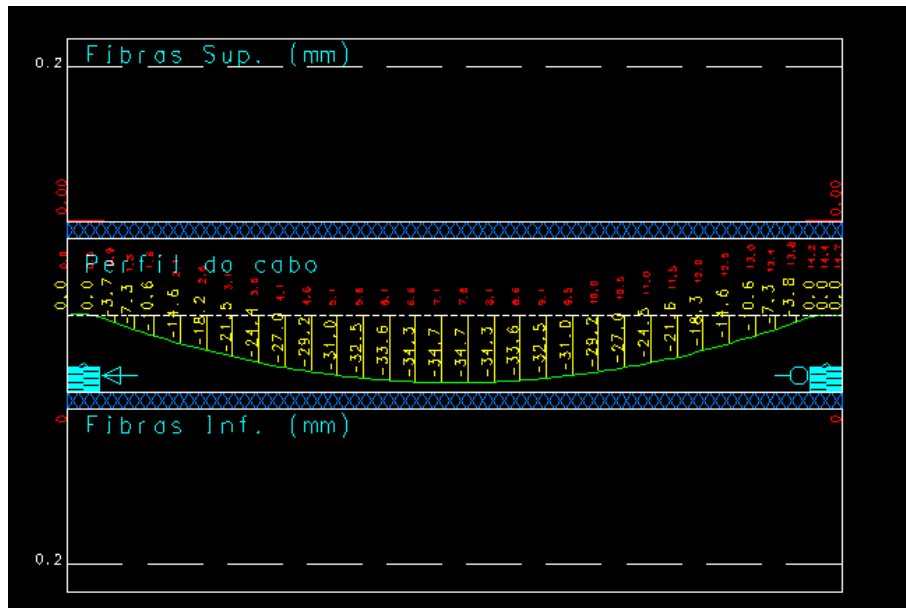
Fissuração viga V10 do 1º pavimento (CAD/TQS)
